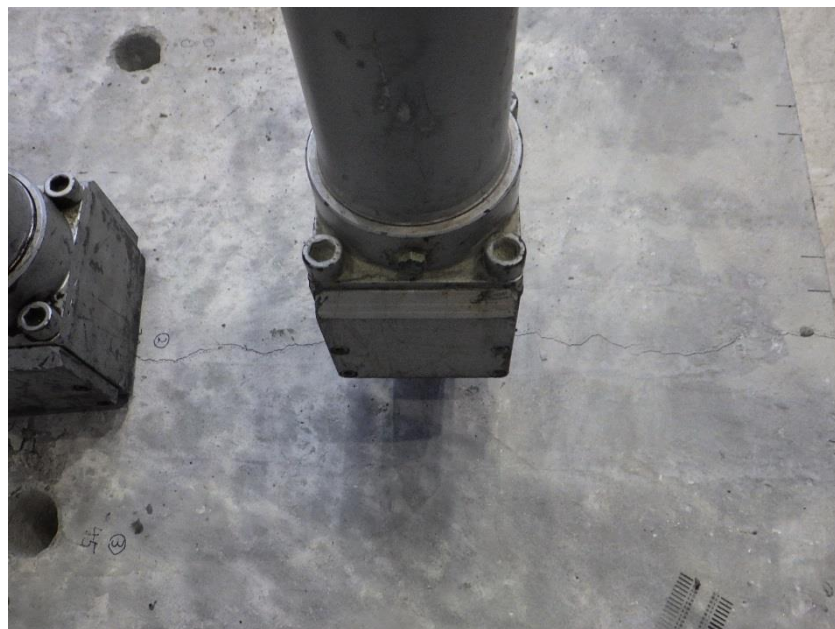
鉄筋コンクリート試験体ひび割れ発生状況 (①・②同時拡張後 1/3)
